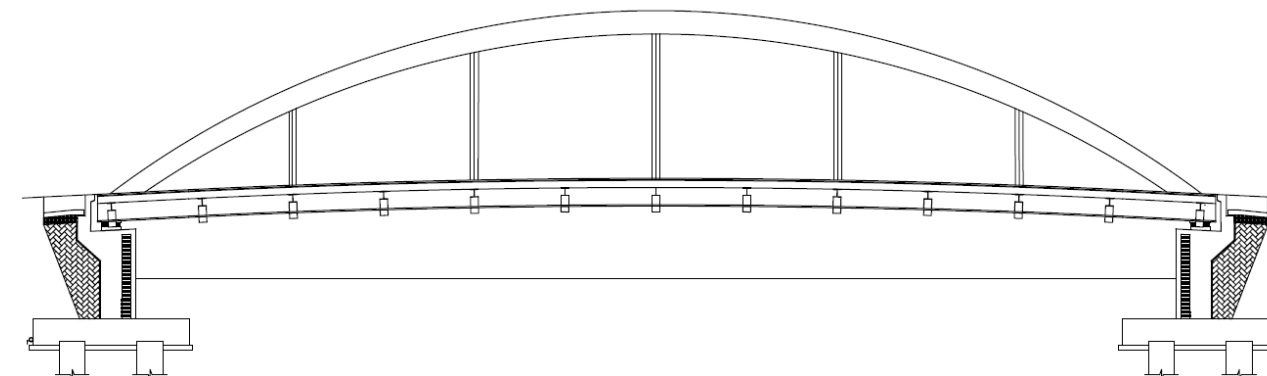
Alzado lateral del puente. Elaboración propia con AutoCAD
